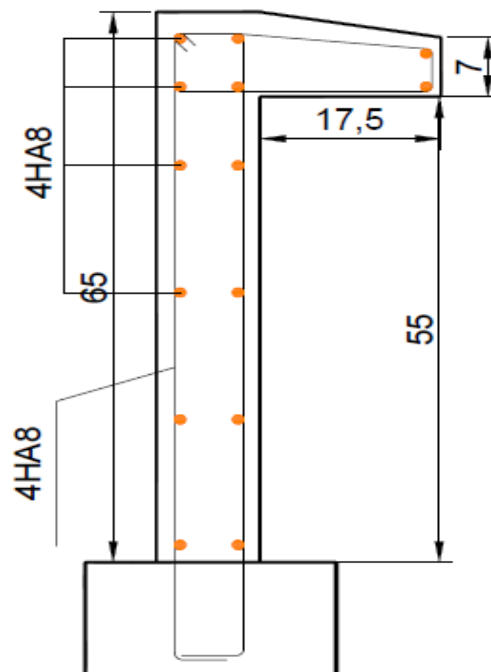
Schéma de ferrailage de l'acrotère
